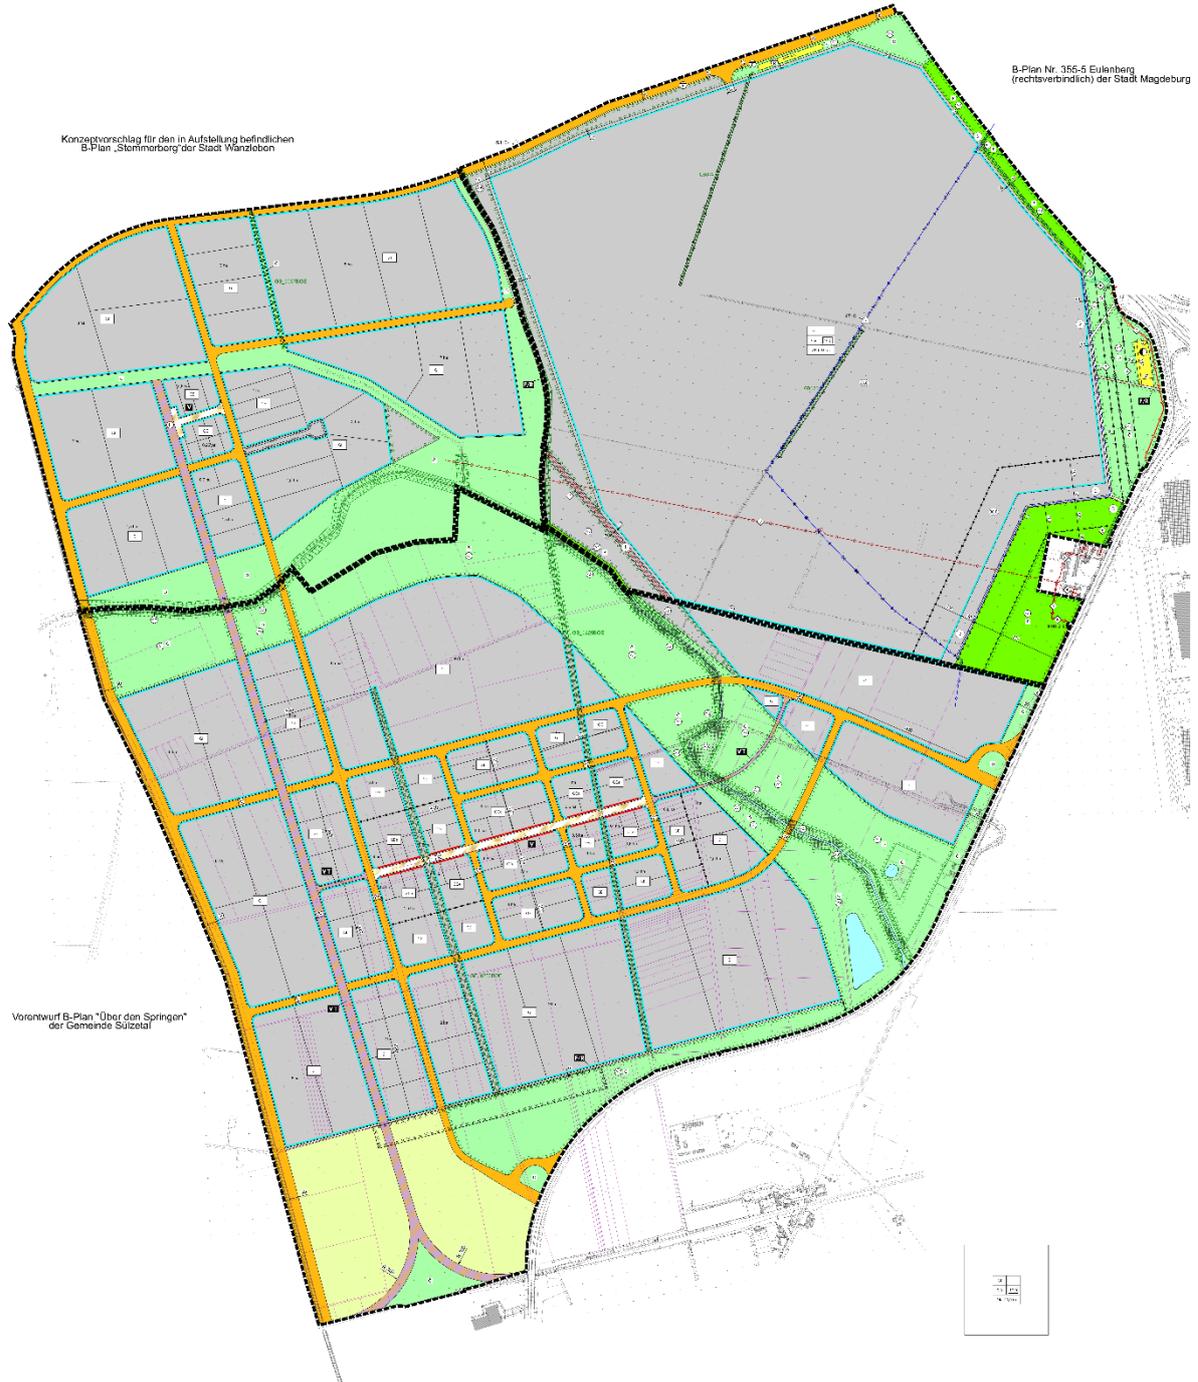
Gesamtplan Hightech Park (o.a.; Stand 12.04.2023)
